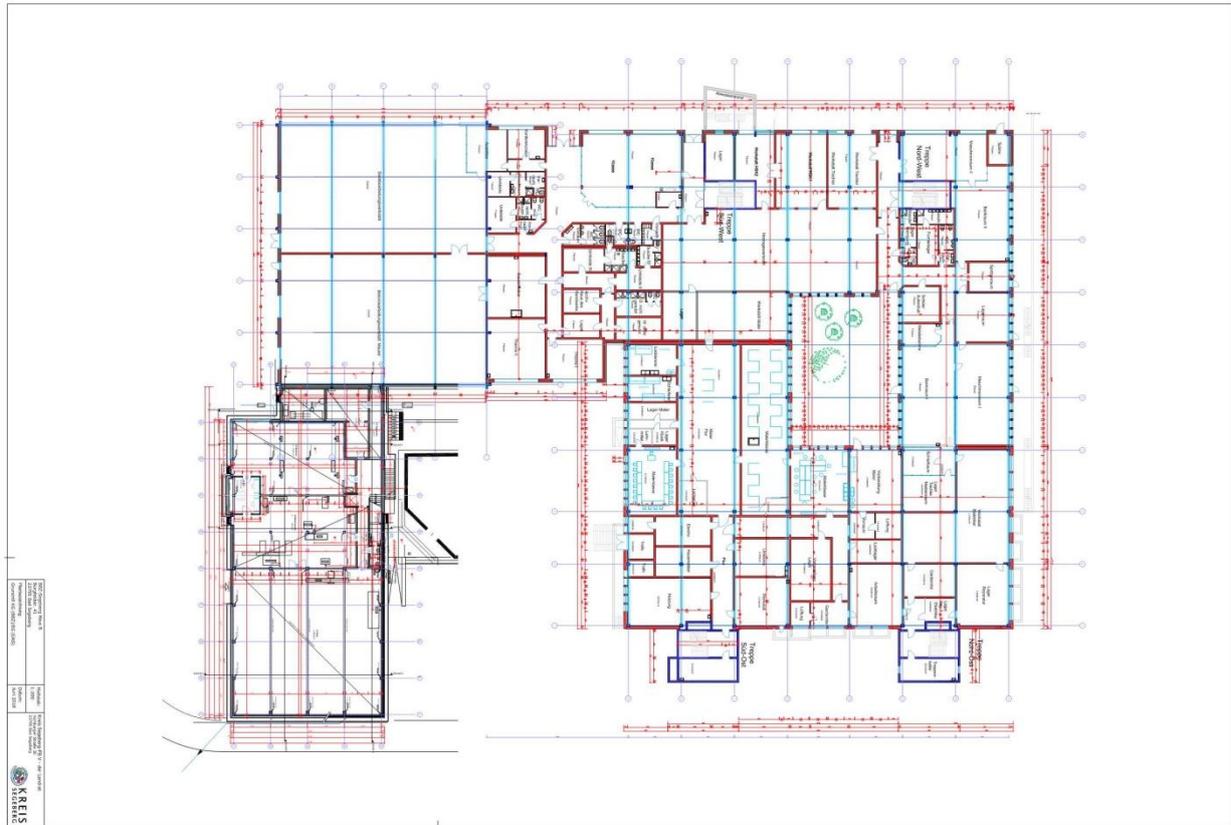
Grundriss Obergeschoss Haus B des BBZ Bad Segeberg, Quelle: Gebäudemanagement Kreis Segeberg
